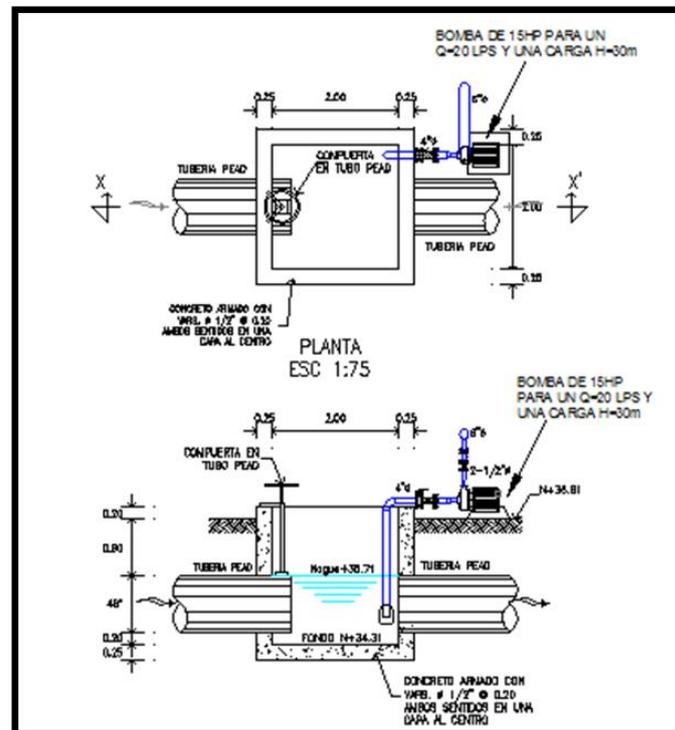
Obra de toma proyectada en la sección de riego sur
